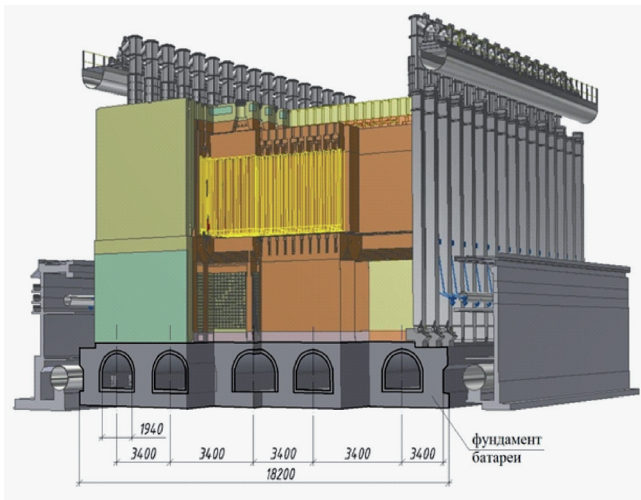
Поперечный разрез коксовой батареи с боковым подводом отопительного газа, включая железобетонный фундамент.
